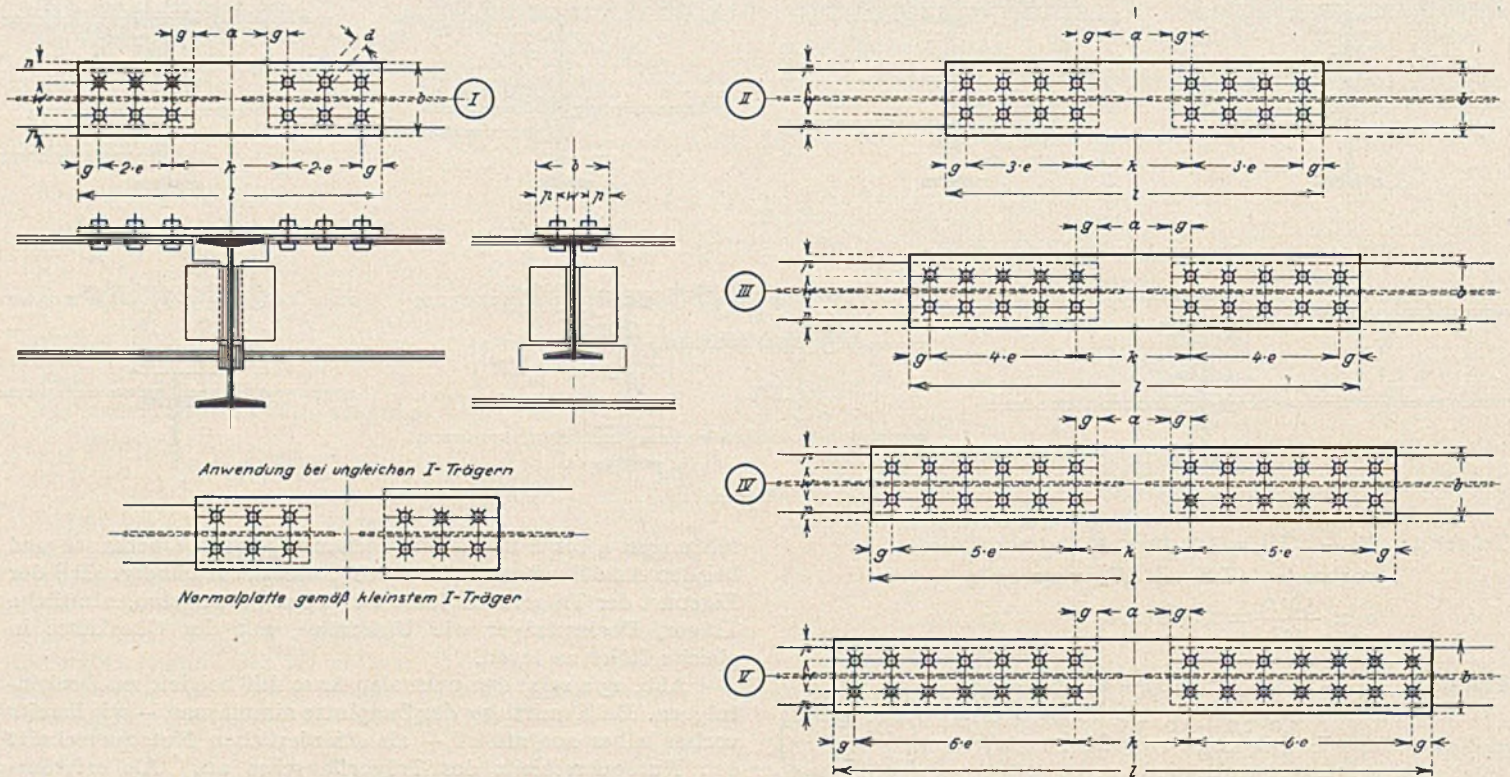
b veranschaulicht den Anschluß bei ungleichen Trägerhöhen bis zu einem Höhenunterschied von 40 mm. Die Druckkraft im unteren Flansch des kleineren Trägers wird in die angenieteten Platten gebracht, die so stark zu bemessen sind, daß Unterkante Platte gleich Unterkante des benachbarten Trägers ist. Bei Anwendung mehrerer Plattenteile sind die einzelnen Platten treppenförmig herauszuziehen und besonders anzuschließen.
